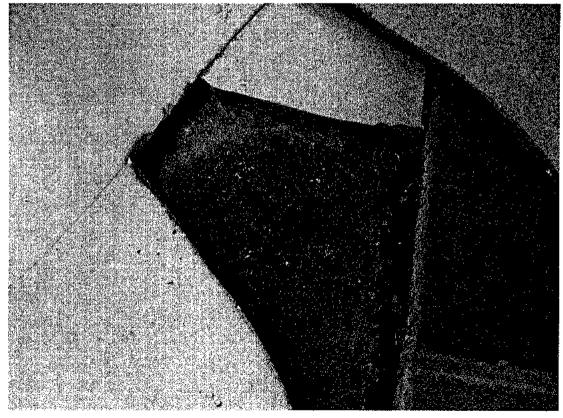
Inerte sottostante parte della pavimentazione del terrazzo
